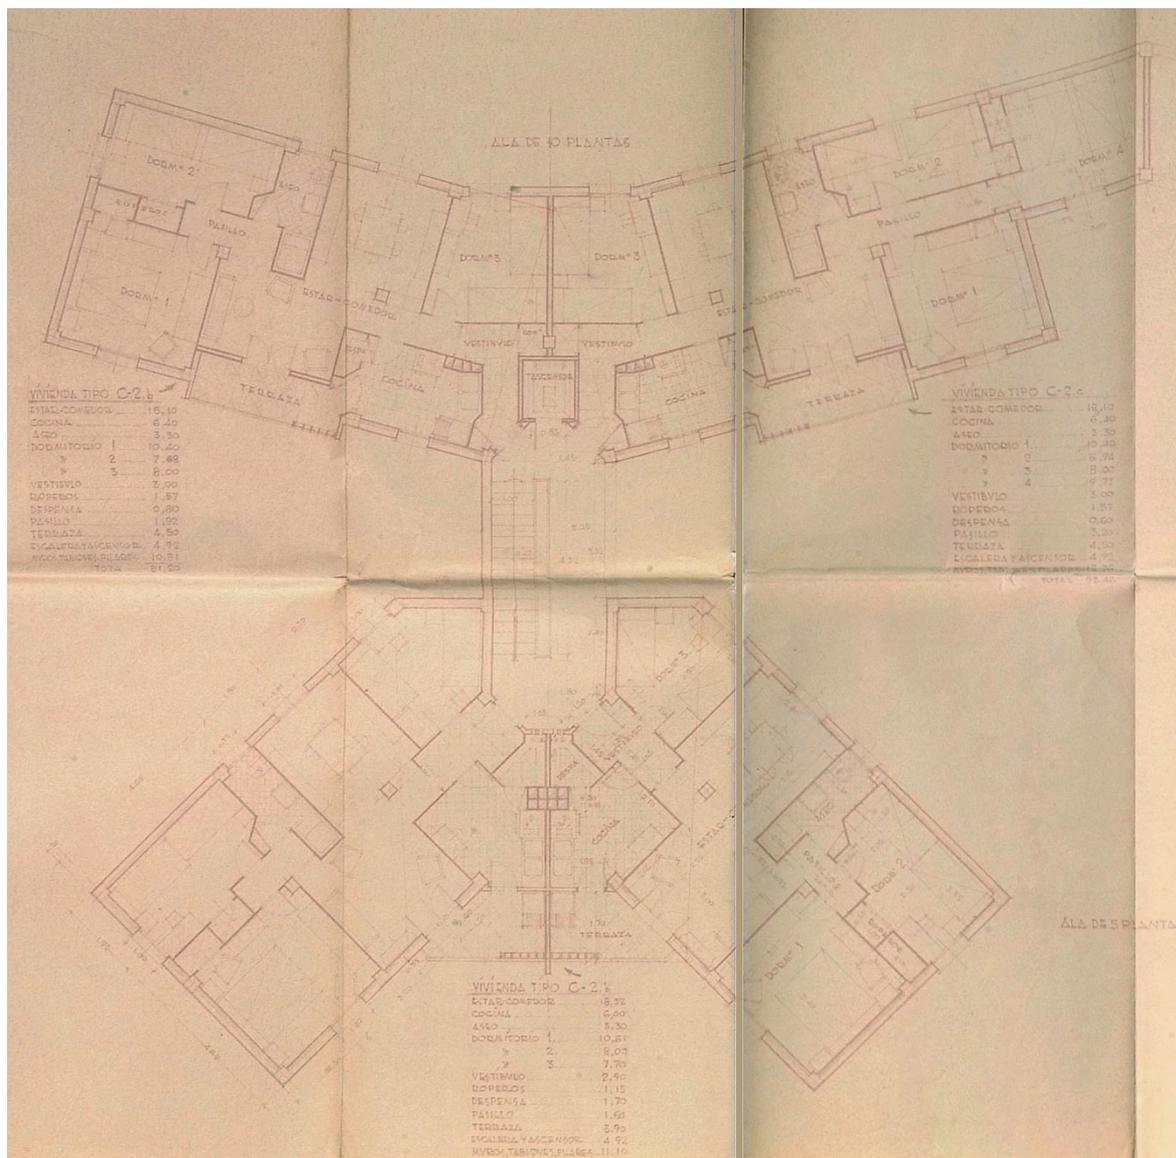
Bloques e H. Planta tipo. ICAS-SAHP, Archivo Municipal de Sevilla, Obras de Particulares
